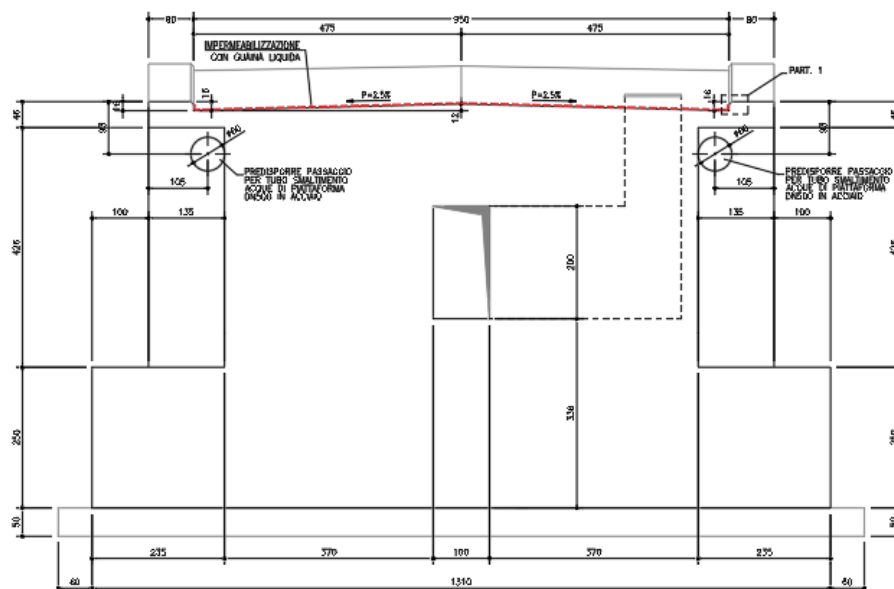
Sezioni trasversale spalle all'incastro con l'impalcato
